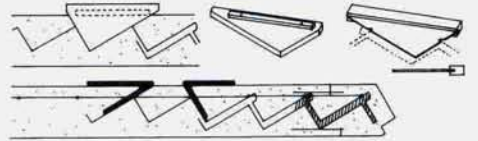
Разметка и установка ступеней прямой лестницы в тетиву.
